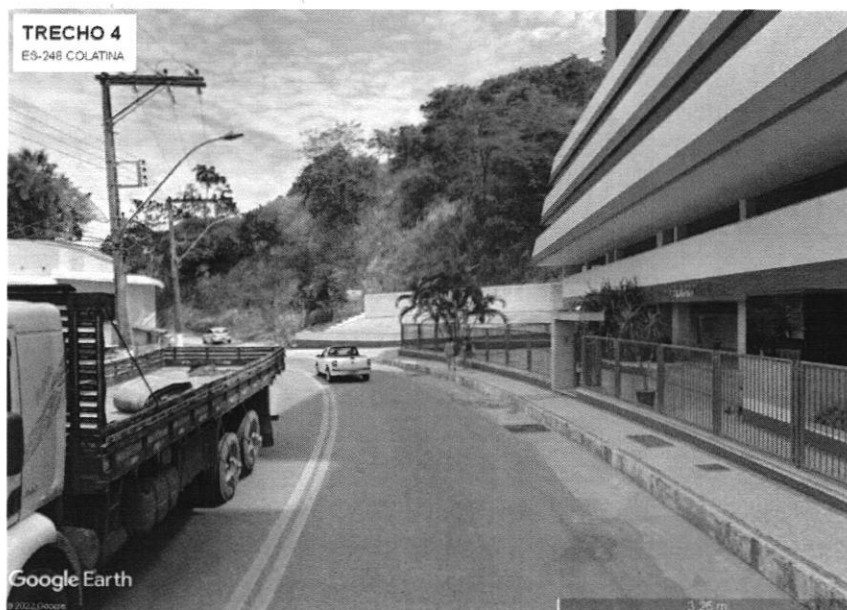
FOTO MOSTRANDO CONSTRUÇÕES, ILUMINAÇÃO PÚBLICA E CALÇADAS
